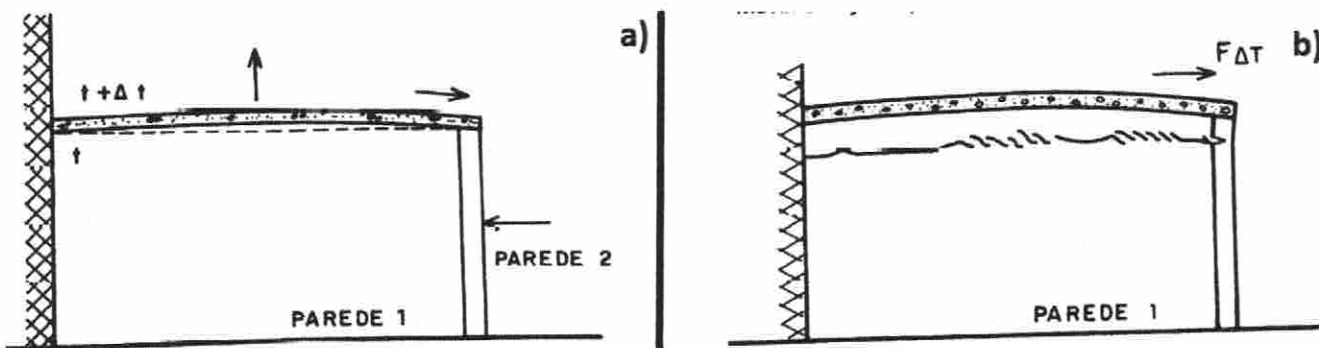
a) Movimentações que ocorrem numa laje de cobertura, sob ação da elevação da temperatura. b) Fissura típica presente no topo da parede paralela ao comprimento da laje. (fonte: Tomaz, E. 2014)
